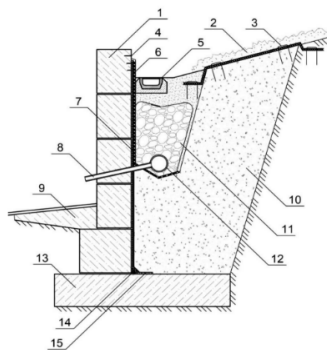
Схема влаштування підпірної стіни зі збірних залізобетонних блоків:
